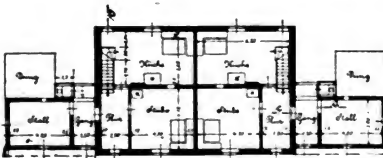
Grundriß zu Abb. 79, Erdgeschoss.
